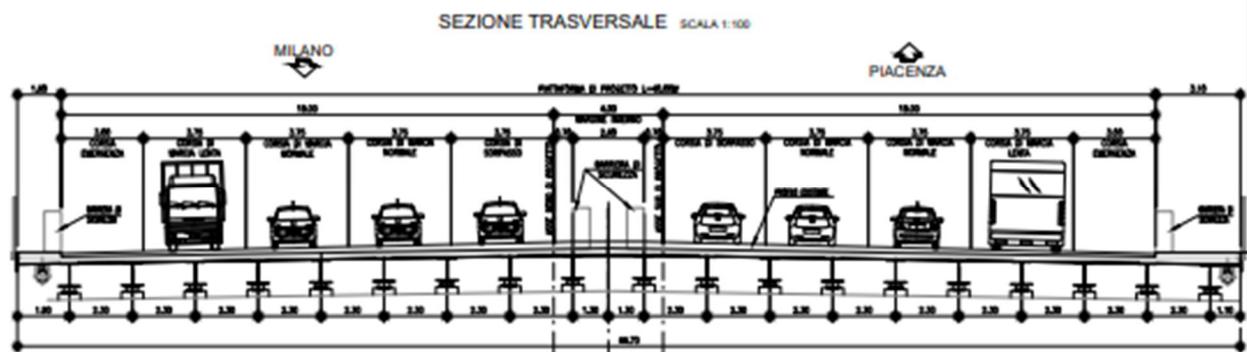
Sezione trasversale Viadotto Lambro – configurazione modificata
